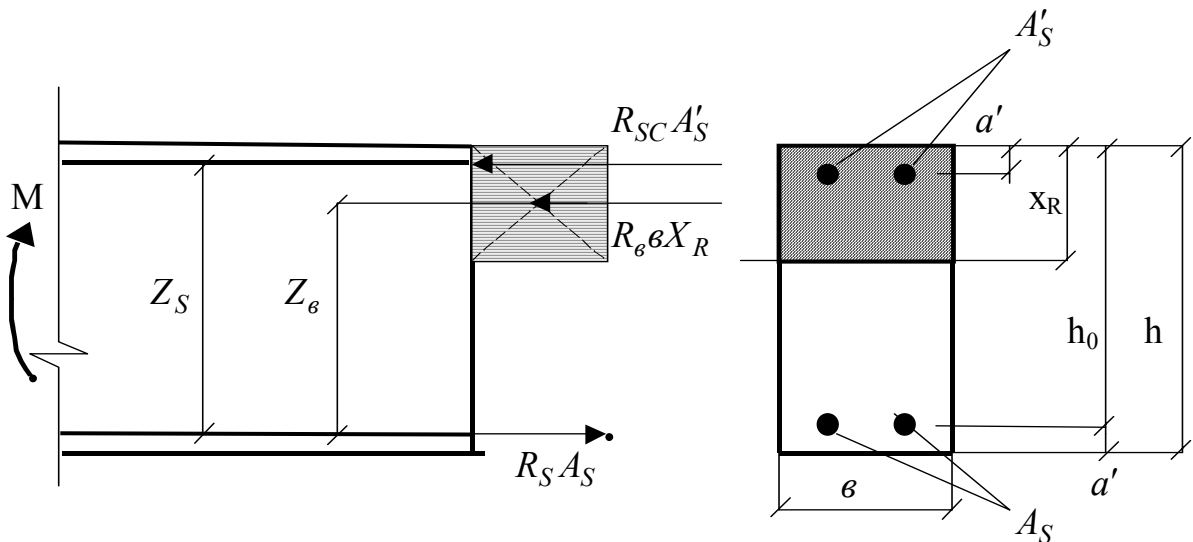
Схема зусиль при розрахунку міцності елемента з подвійною арматурою
